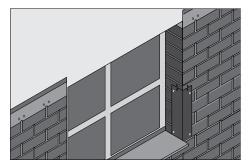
Монтаж уголка внешнего сбоку проема.
